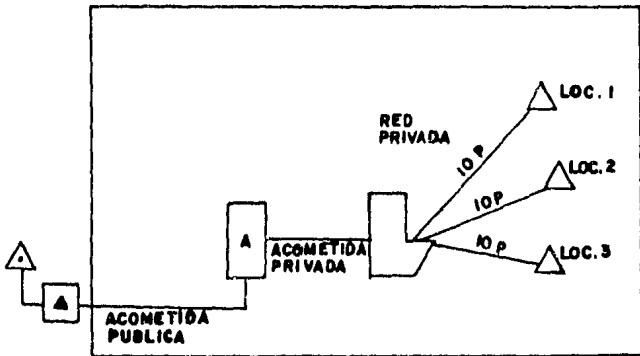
f. INSTALACION EN UNA PLANTA
